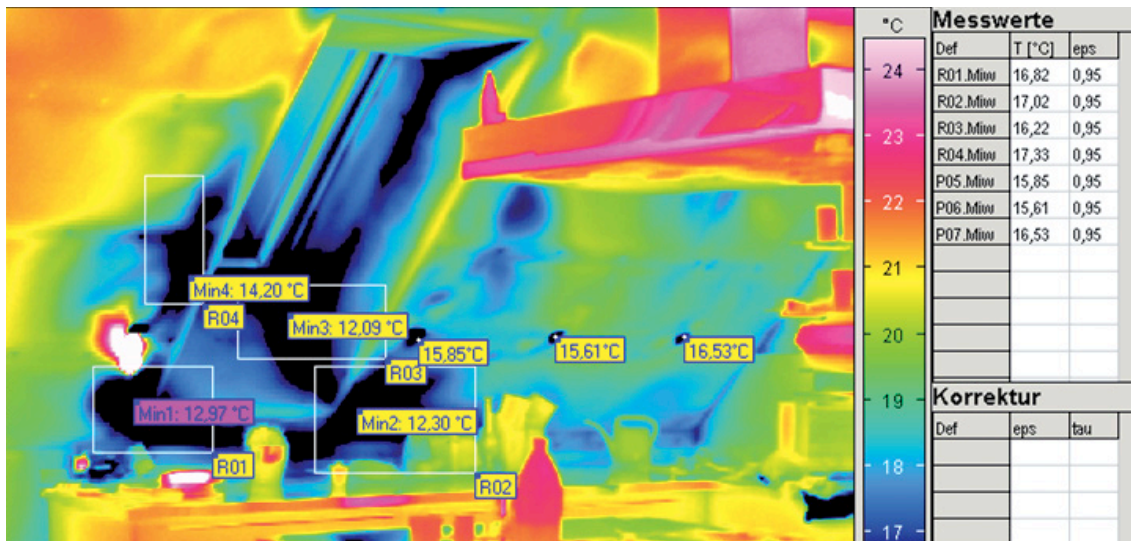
mangelhafter Einbau Dachflächenfenster in einer Küche
